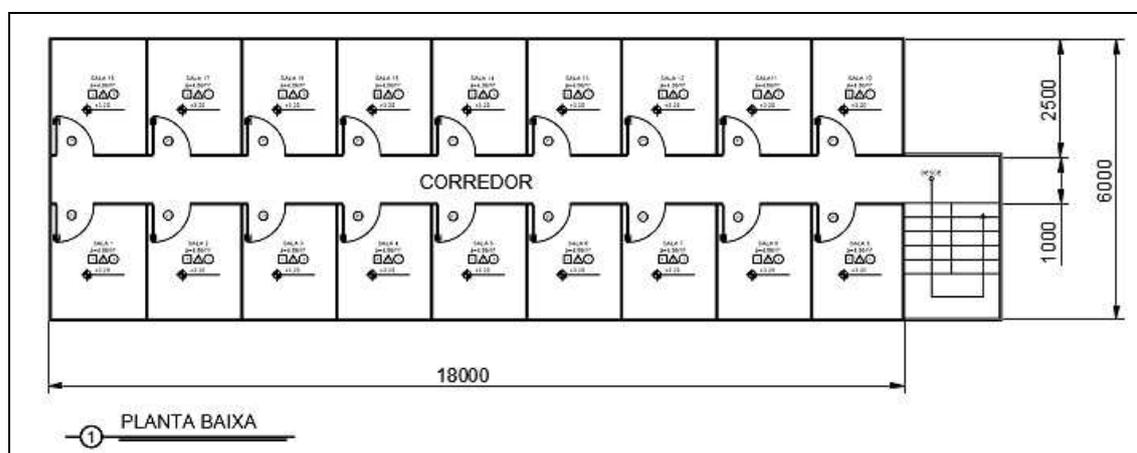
Planta baixa do projeto, com dimensões na escala cm x cm. (Arquivos do projeto)
